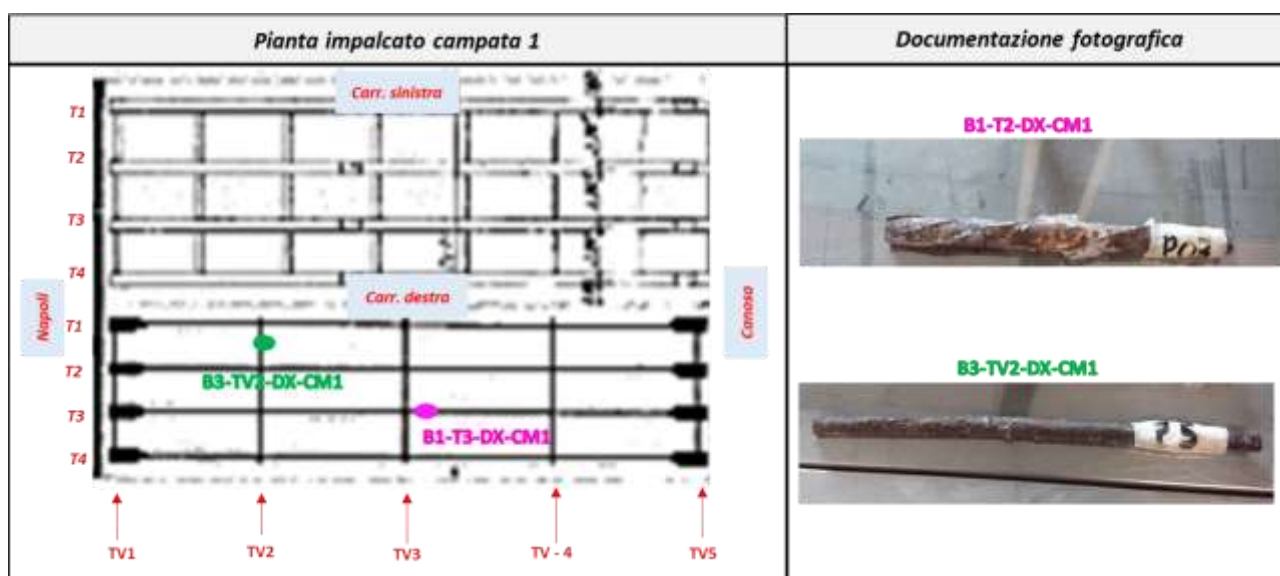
Ubicazione prove in pianta e documentazione fotografica – Prelievo e prove su barre di armature
